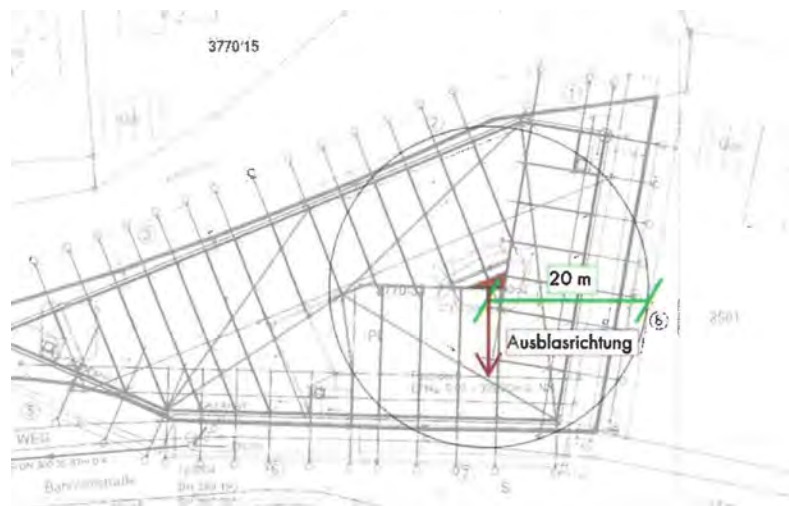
Dachaufsicht Parkhaus mit Lage Fortluftöffnungen
